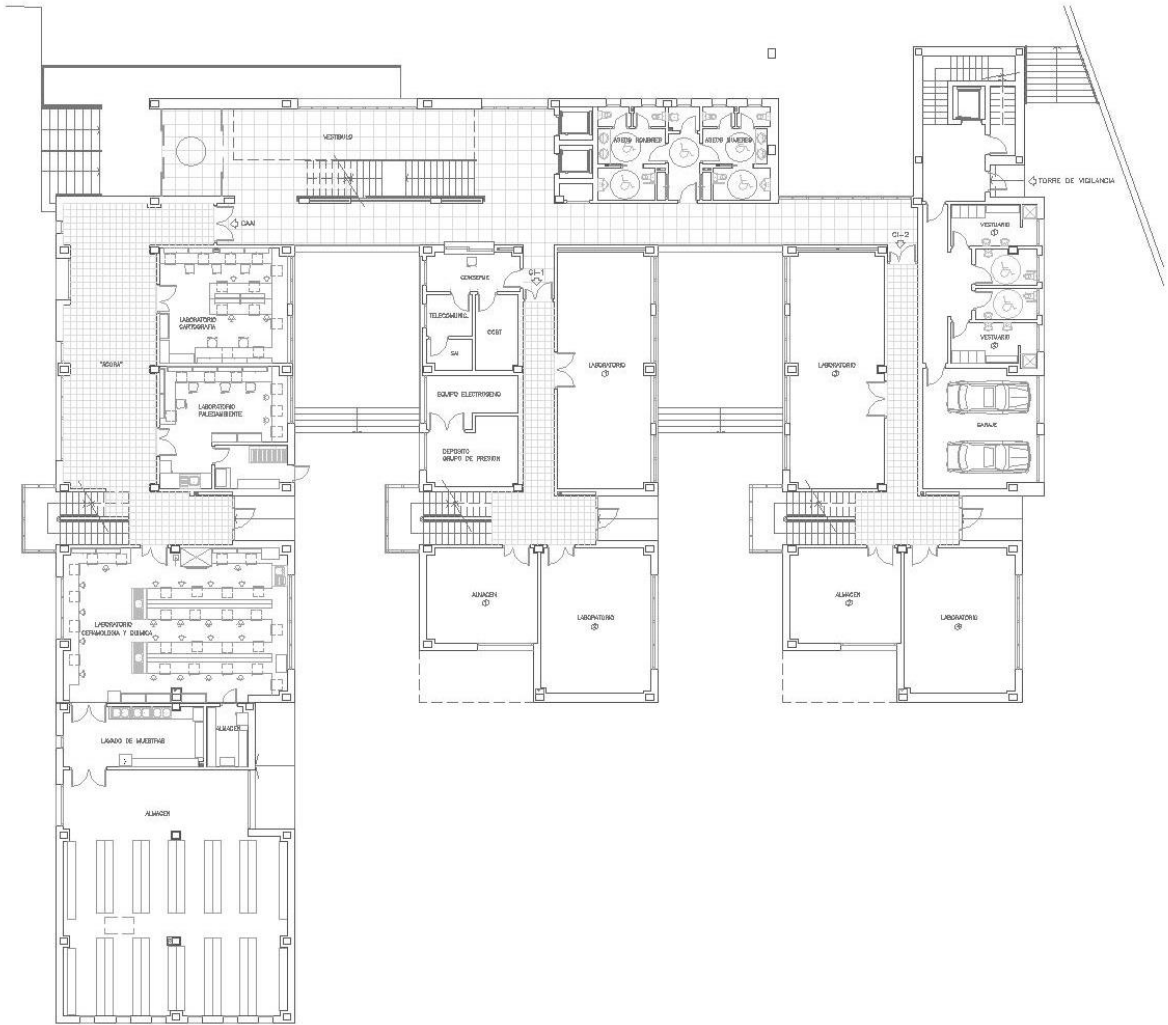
Planta baja. Fuente: Proyecto técnico de ejecución.
